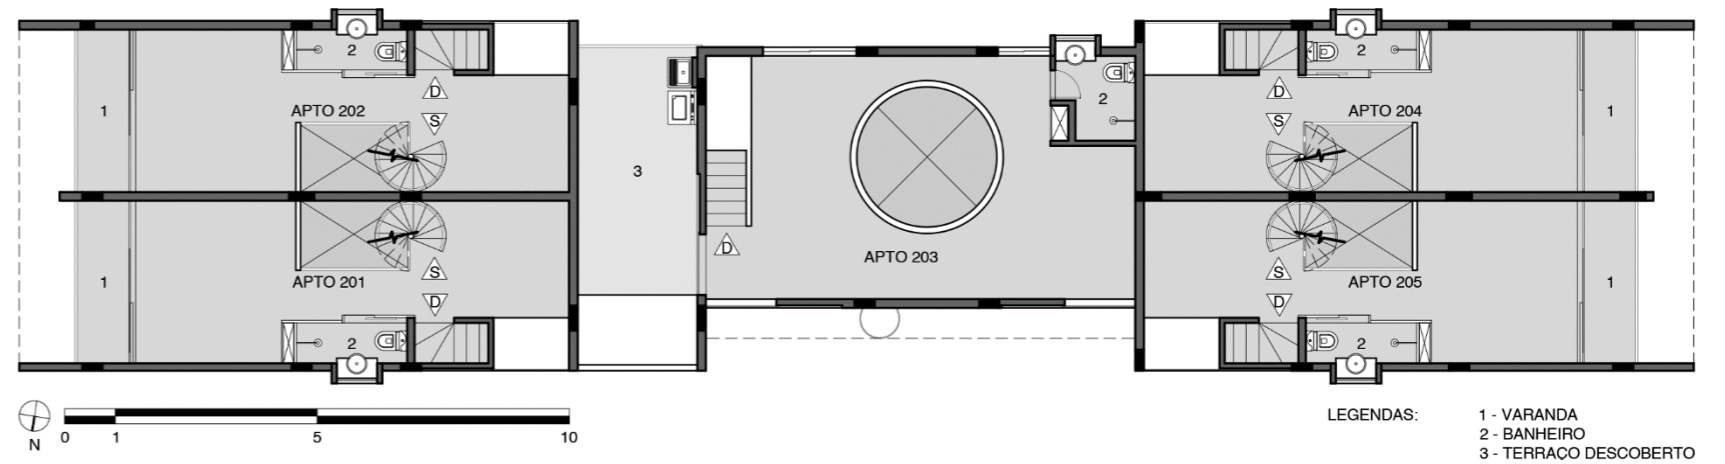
Planta do quarto pavimento dos Estúdios Capelinha
